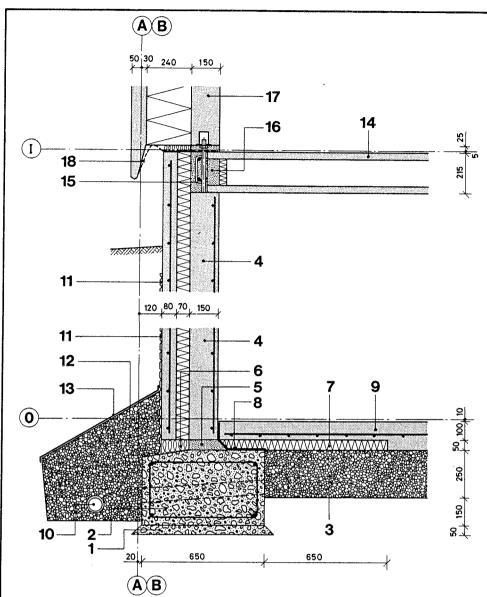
Kælderydervæg i facadelinien med tilgrænsende hovedkonstruktioner, lodret snit, 1:20. 1 renselag, 2 armeret rendefundament med stikdræn, 3 kapillarbrydende lag, 4 betonsandwichelement, 5 understopning med cementmørtel, 6 mineraluldstopning, 7 ekstra randisolering, 8 påklæbet asfaltpap, 9 armeret kældergulv, 10 omfangsdræn, 11 Platon Grundmursplade, 12 singelskasse, 13 afdækning med asfaltpap, 14 215 mm extruderet forspændt huldækelement, 15 bøjleforankret fugearmering, 16 udstøbning imod mineraluldstopning. 17 facadeelement, 18 Fibertex påklæbet elementtå.
